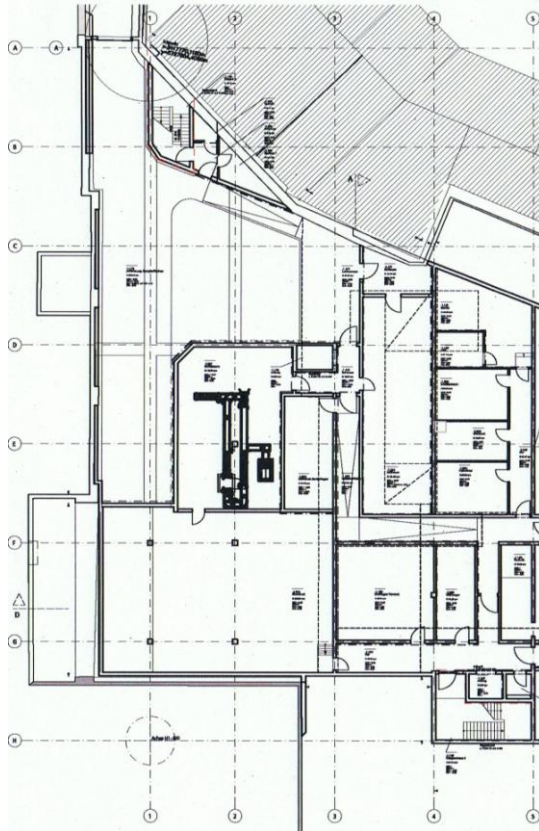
Grundriss Erdgeschoss Zentralbibliothek Hamm
